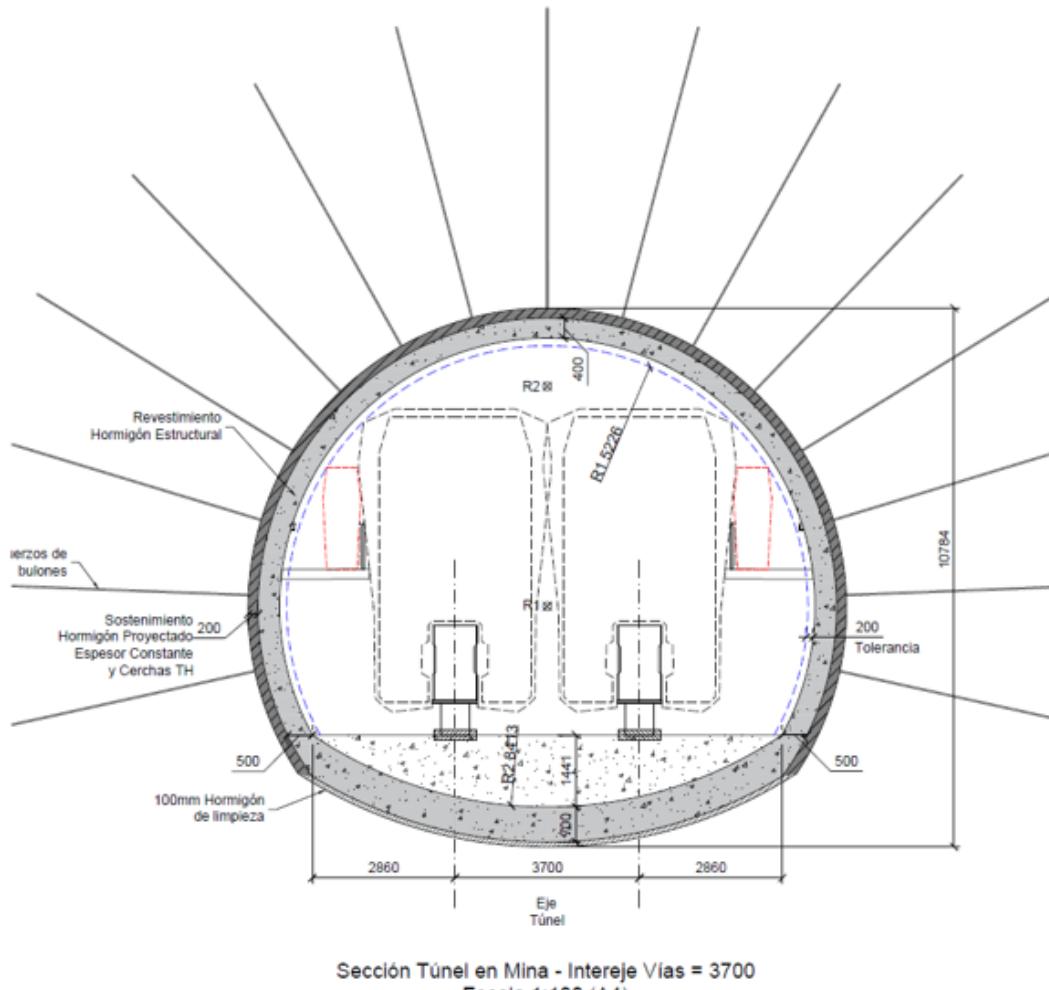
Sección Preliminar Túnel en Mina (NATM) – Anclajes
